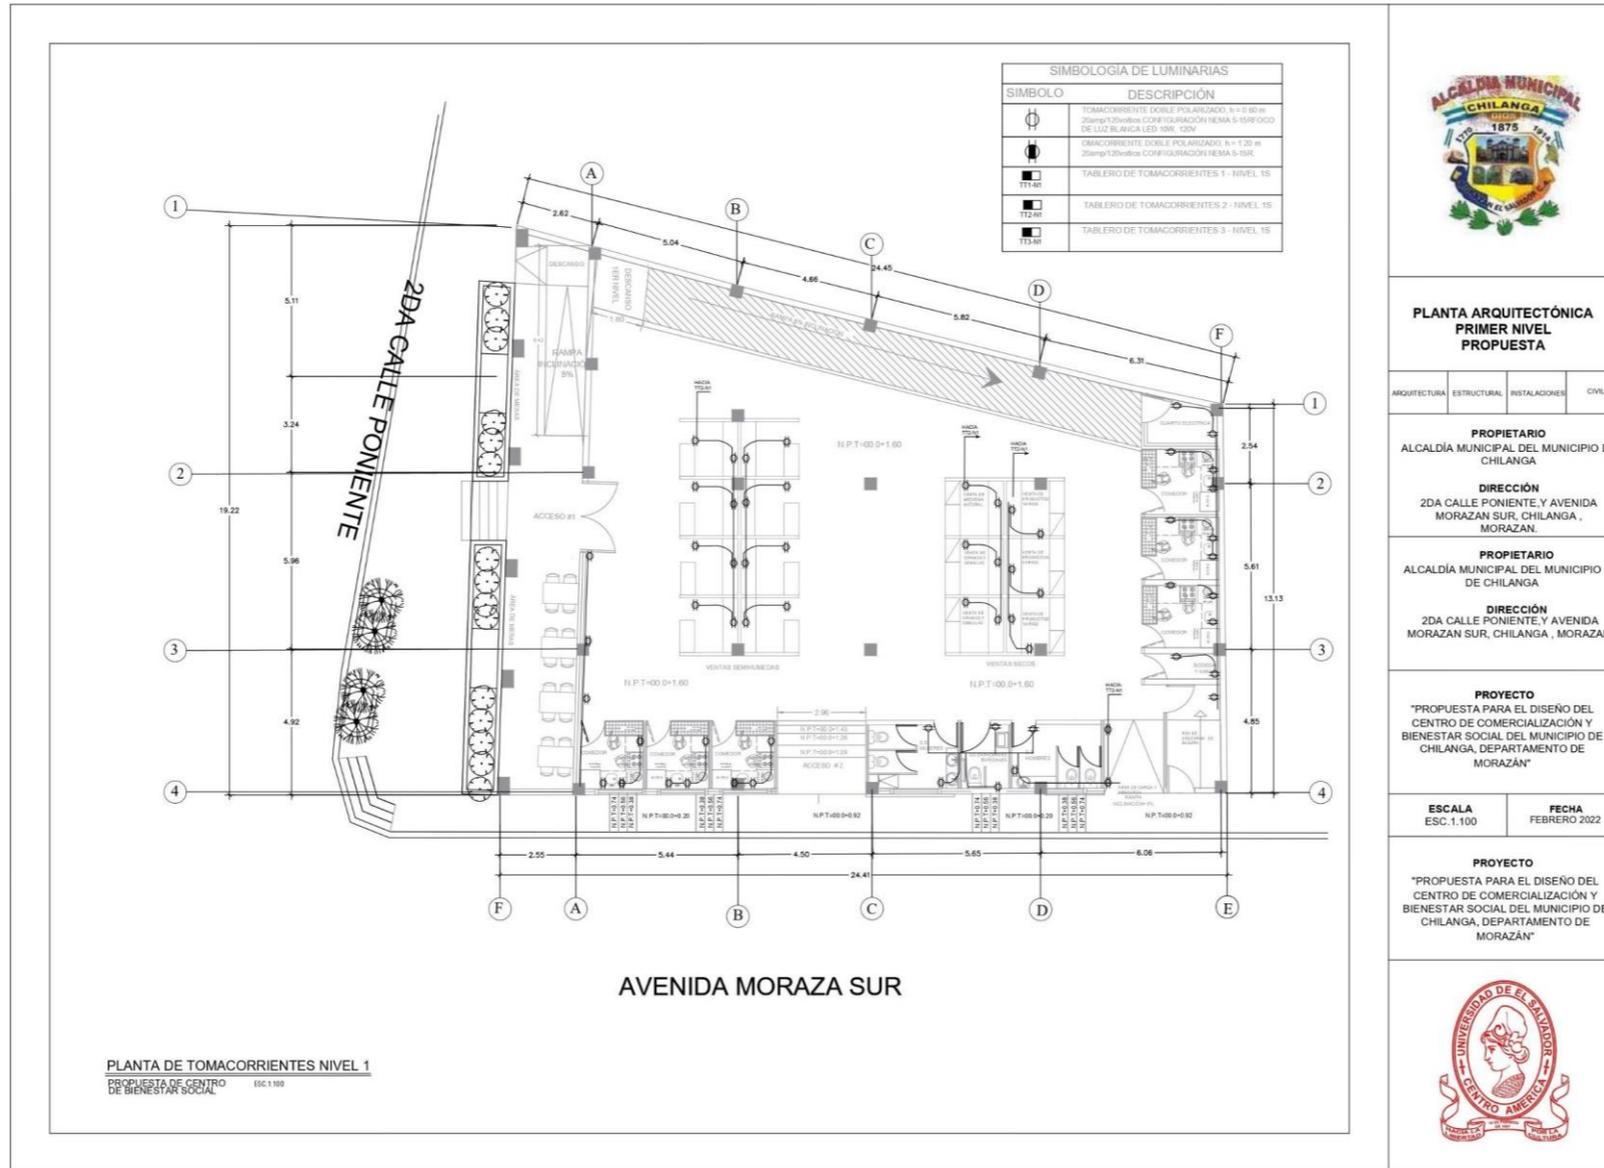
Planta de Tomacorriente Primer Nivel Propuesta
